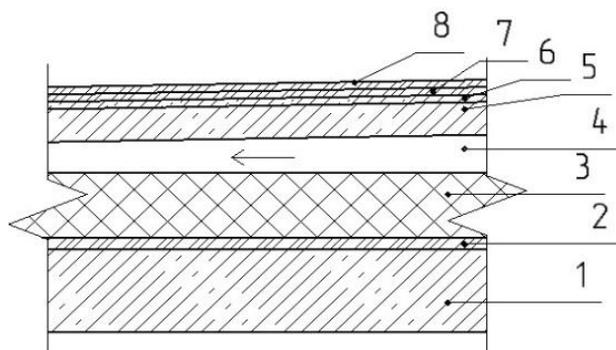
Вентилируемая неэксплуатируемая кровля:
